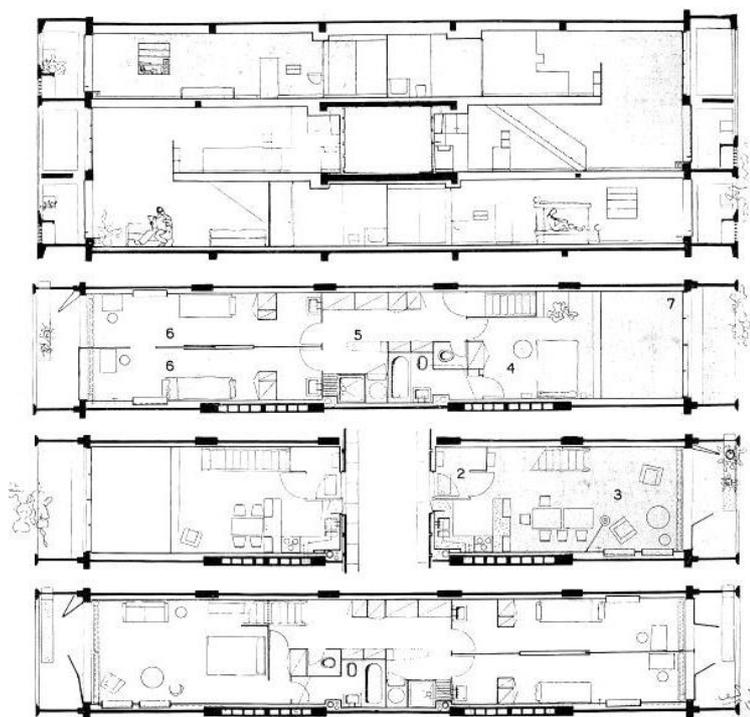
Planta tipo e corte longitudinal dos apartamentos da Unidade de Habitação
